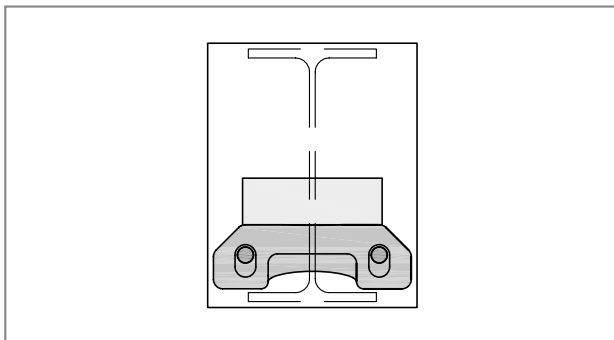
Schöck Isokorf® T type SQ: verdraaide en verschoven elementen door onvoldoende fixatie tijdens het beton storten
